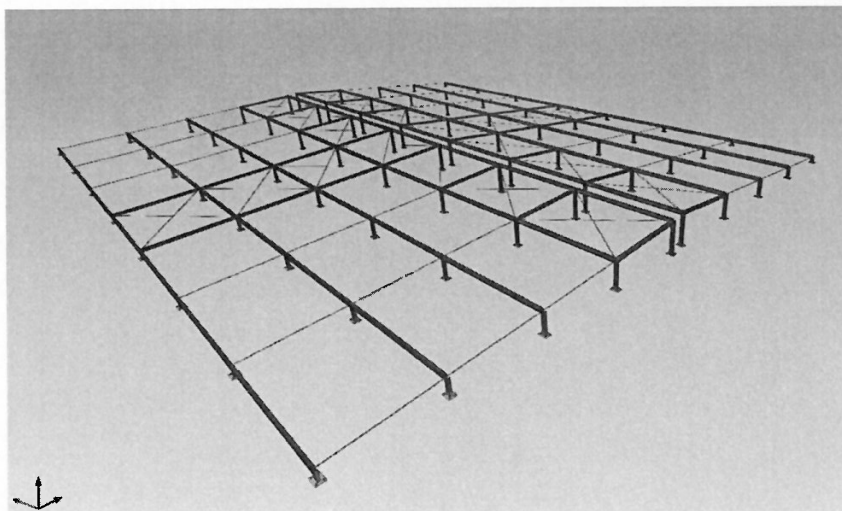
Imagem em 3D da concepção geral da estrutura metálica.
